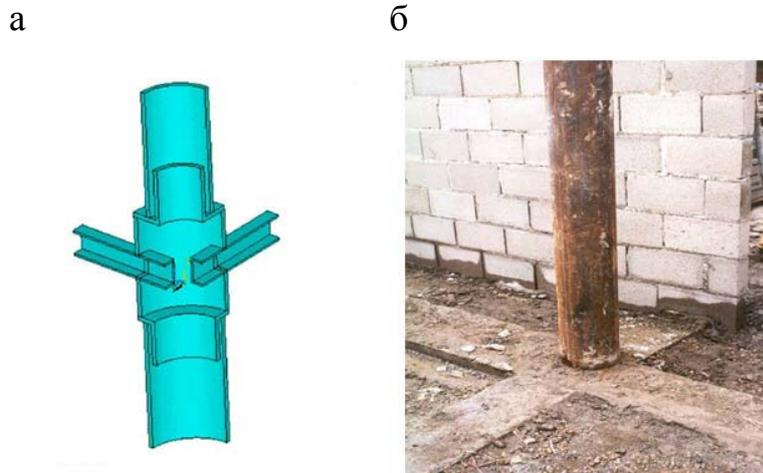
Элемент узла сопряжения труботетонной колонны с перекрытием (а), вид узла сопряжения в строящемся здании (б)
